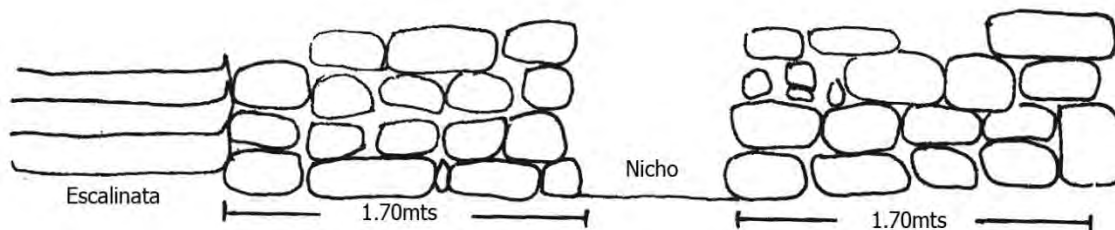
Croquis de la fachada principal en la base de la Estructura 13R-9 (Dibujo por A. Cajas)
